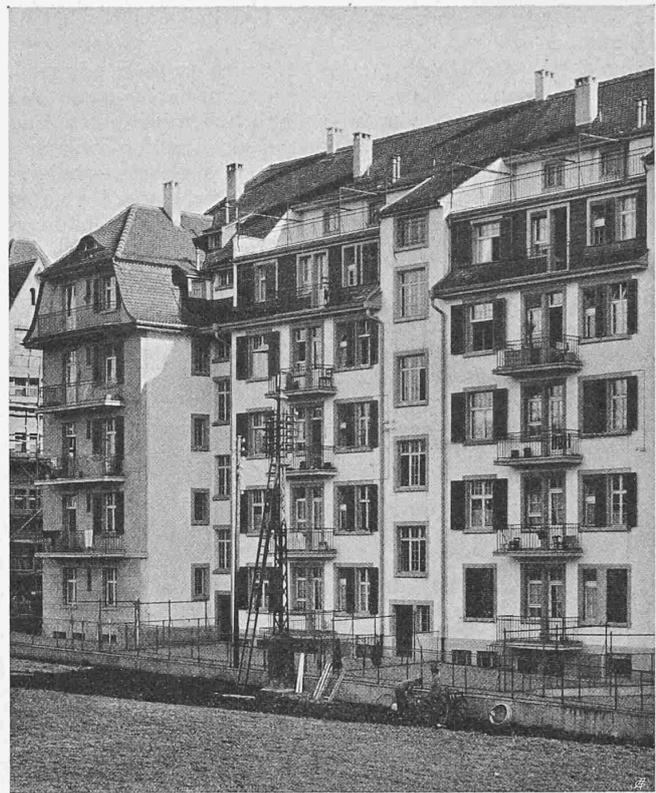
Rückansicht mit den ausgebauten Dachgeschossen.
